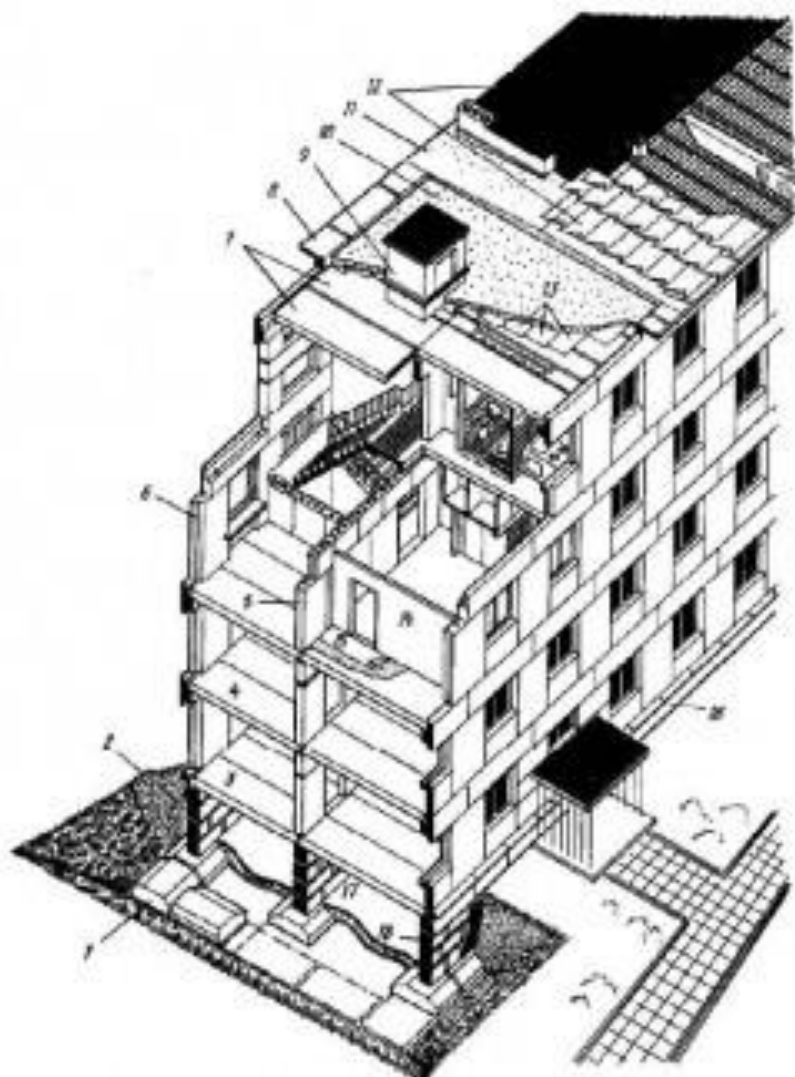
Крупноблочный жилой дом: 1 — опорная щита фундамента, 2 — гидроизоляция, 3 — надподвальное перекрытие, 4 — междуэтажное перекрытие, 5 — внутренняя несущая продольная стена, 6 — наружная несущая стена из крупных блоков, 7 — настил покрытая, 8 — сборный карниз, 9 — люк (выход на крышу), 10 — утеплитель, 11 — цементная стяжка, 12 — совмещенная крыша, 13 — пароизоляция покрытия, 14 — перегородки, 15 — пол (линолеум), 16 — цоколь, 17 пол по грунту, 18 — стена
